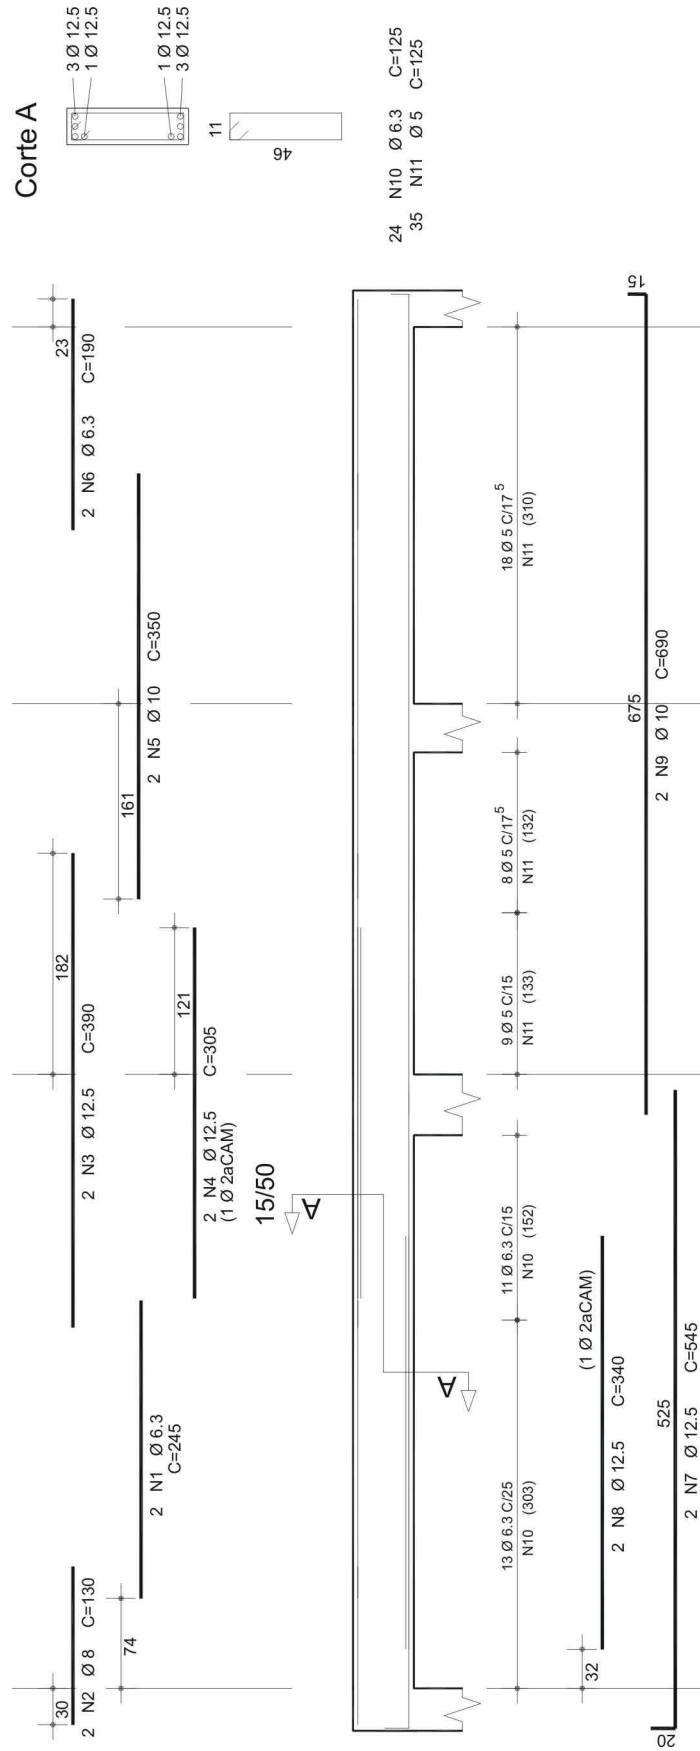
Detalhamento Viga 04, realizado pelo CAD/TQS.
